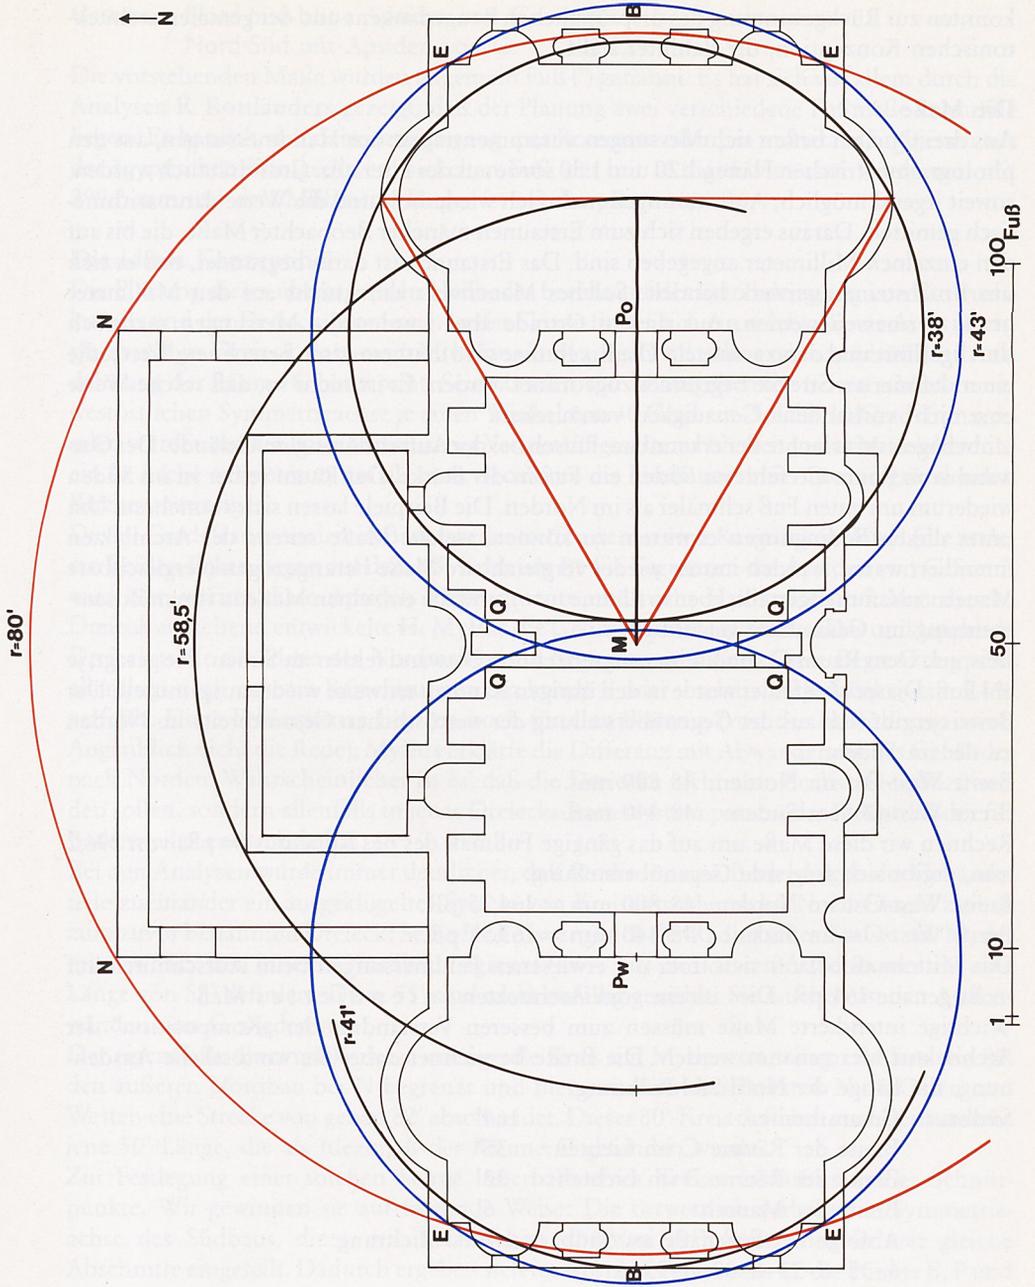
Plan des Römerbades in Badenweiler mit Einzeichnung von Planungskreisen und eines Planungsdreiecks.
